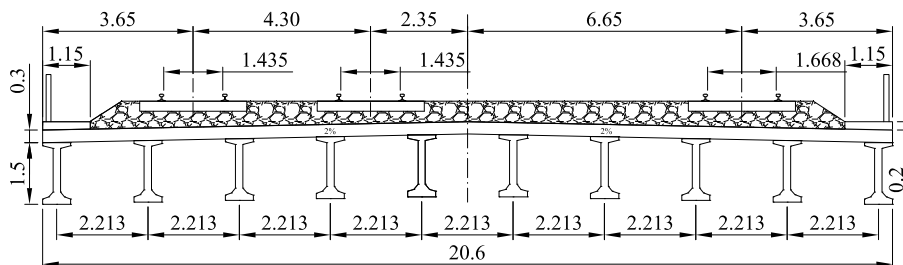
Sección transversal recta del puente Argamasilla. Unidades (m)
